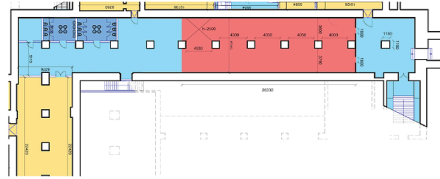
Lecture Hall genel görünüşü ve plan şeması
